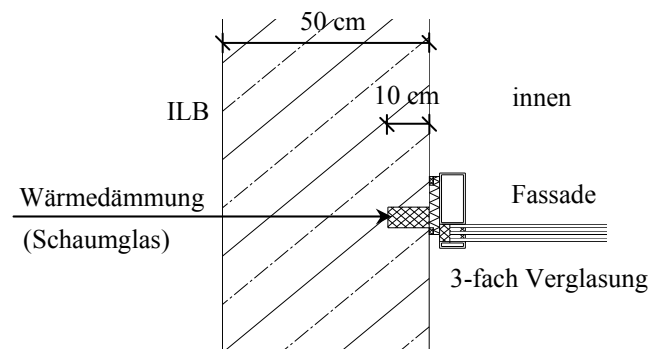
Anschluss Wand – Fassade (Horizontalschnitt)
